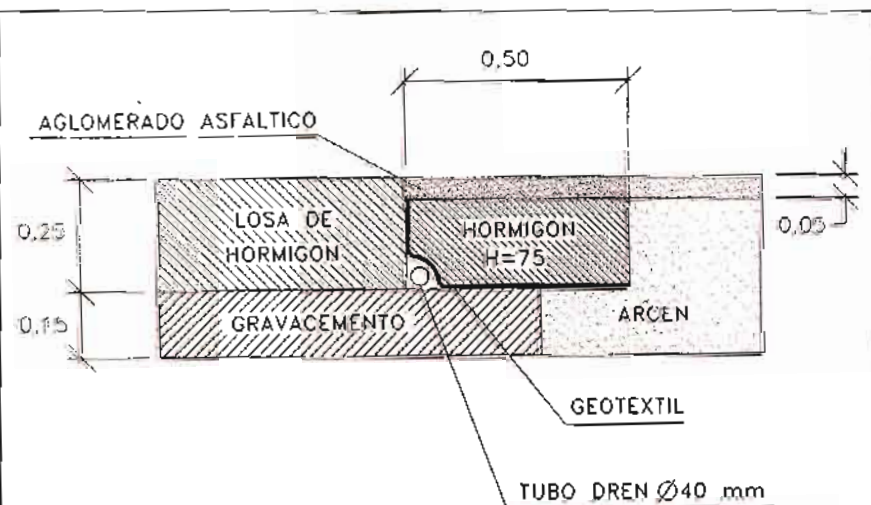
SISTEMA DE DRENAJE LONGITUDINAL DEL FIRME EN AUTOPISTA A-7, PARA TRAMOS EN SERVICIO.
